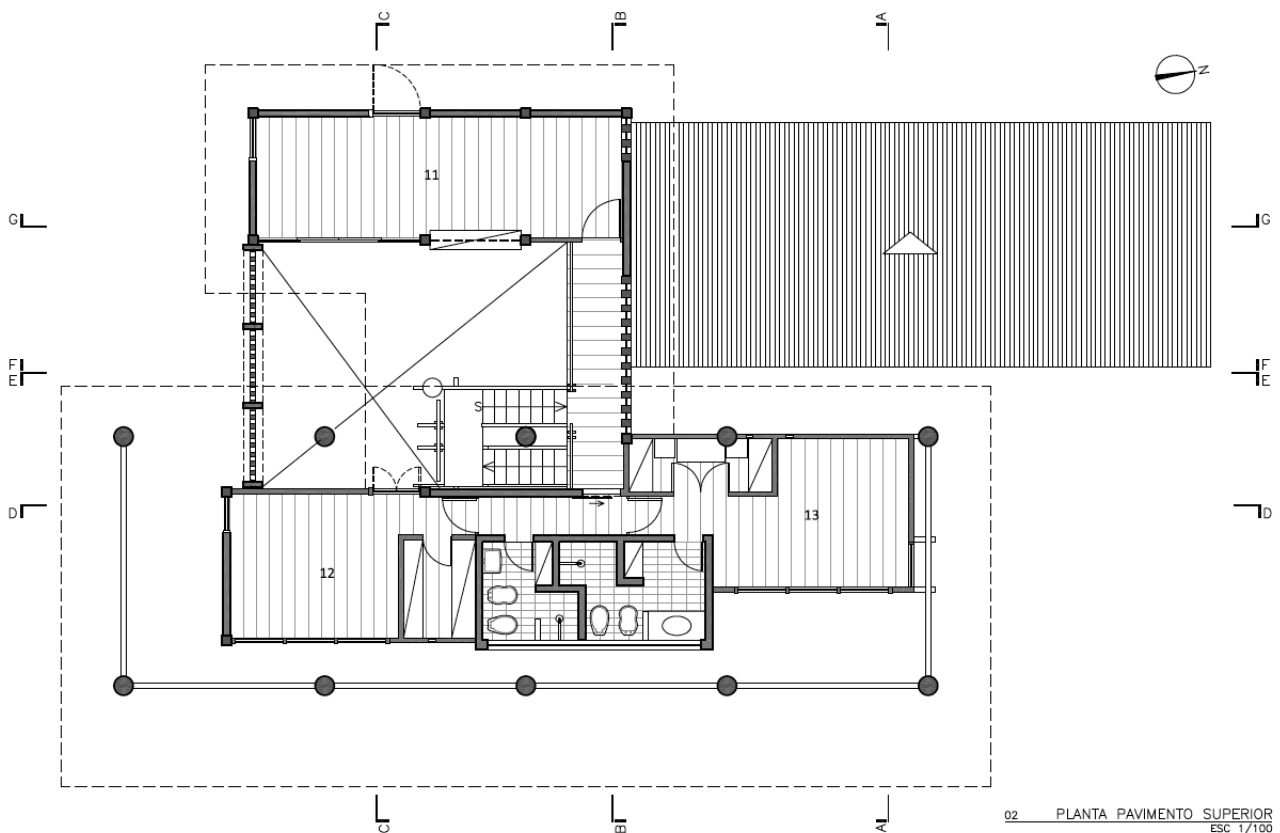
Recife, 1435. Planta do segundo pavimento.
